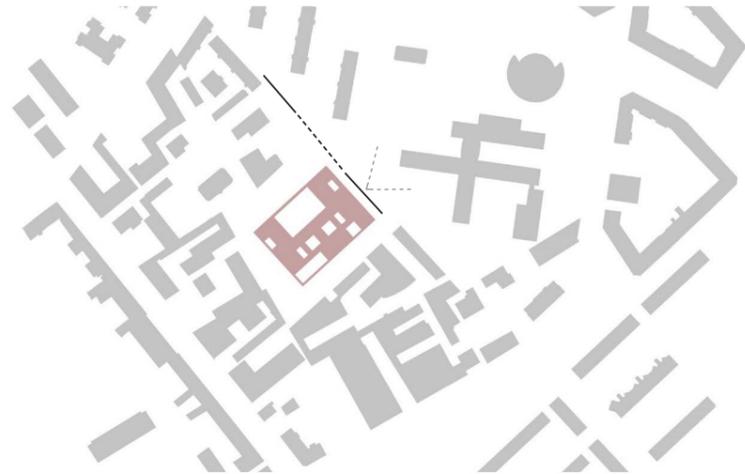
| Schema planimetrico con definizione del fronte strada
